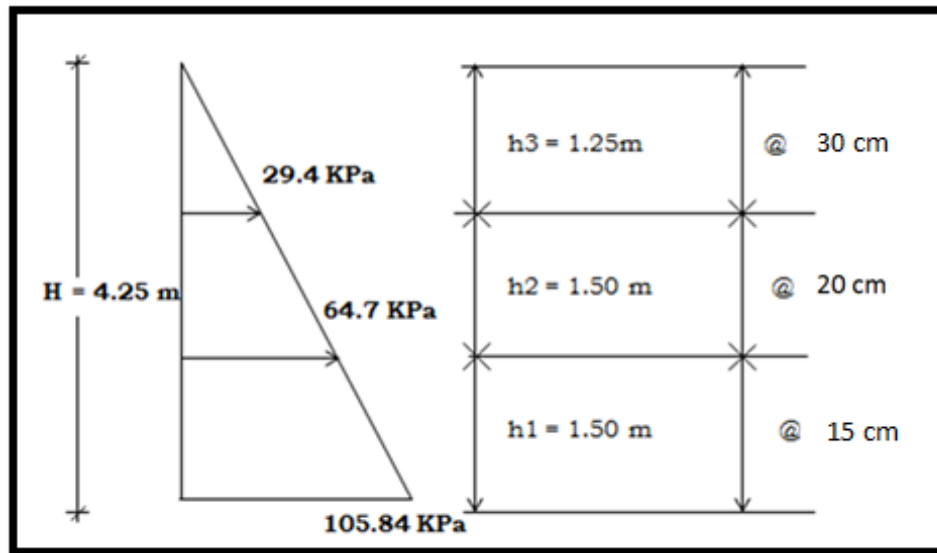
Distribución de presiones y refuerzo en columna diseñada. (Elaboración propia).
